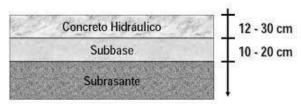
Sección transversal de la estructura de pavimentos rígidos⁴
